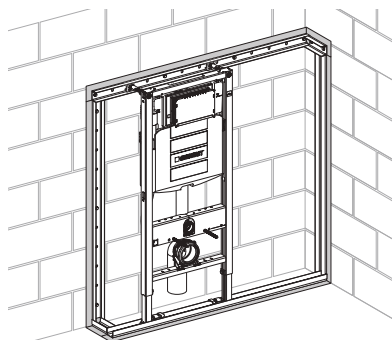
Installazione applicata davanti alla parete ad altezza parziale, realizzata con sistema Geberit Duofix
